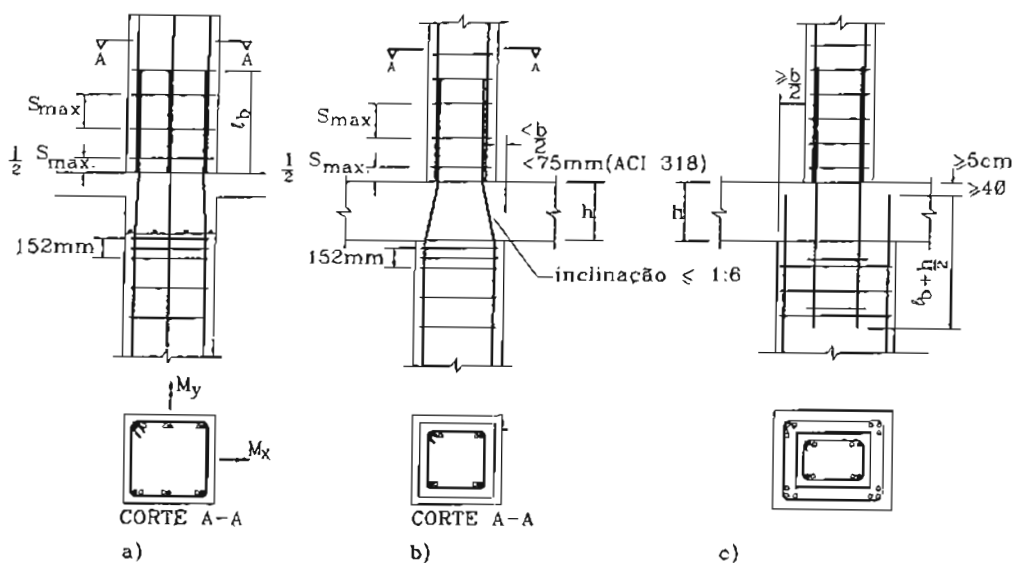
Emendas por traspasse junto às lajes de pisos
